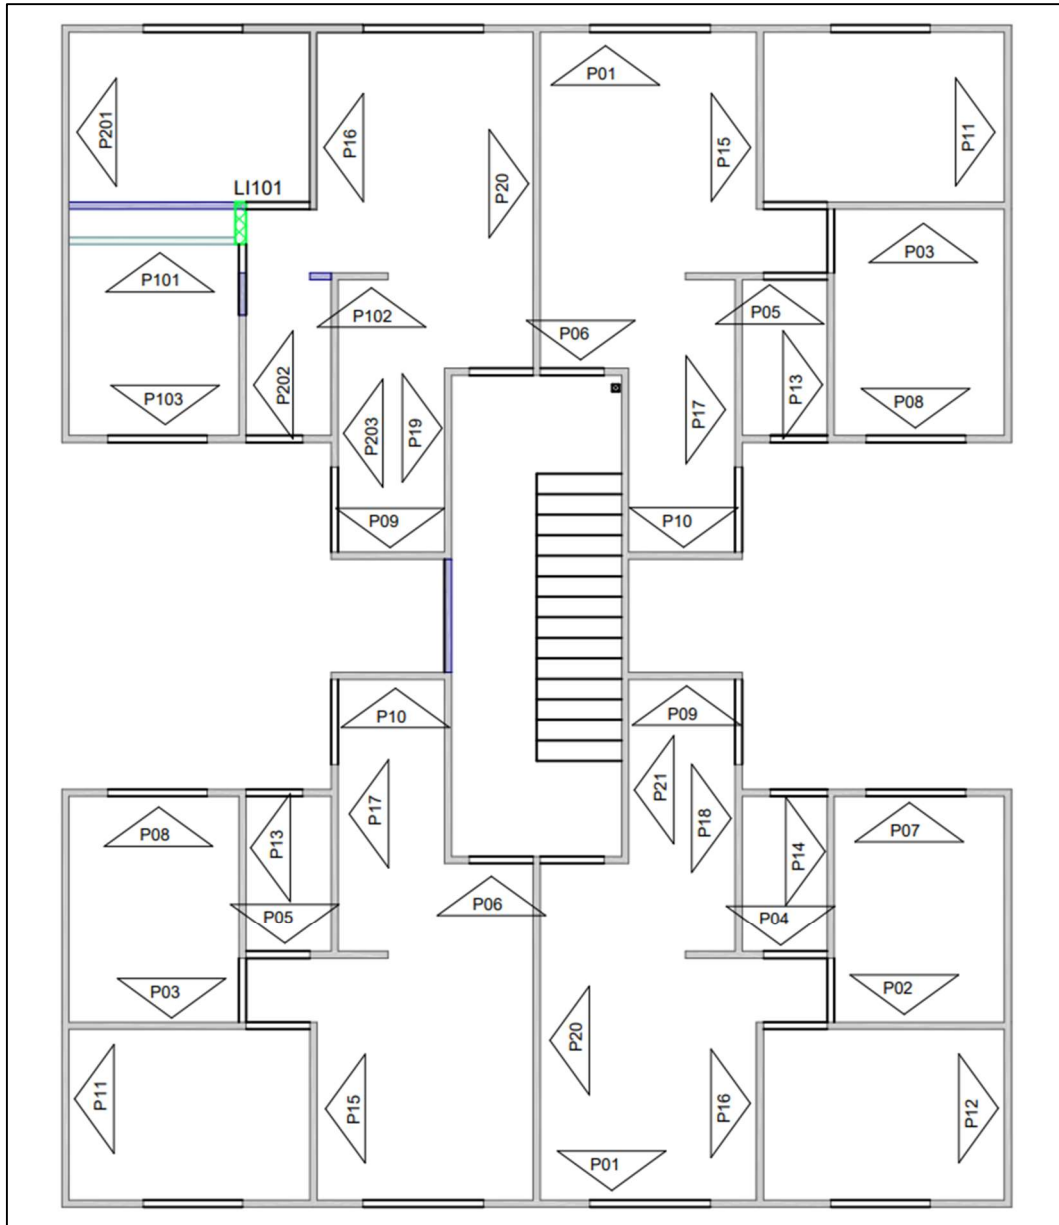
Indicação da parede excêntrica do apartamento adaptado PNE (Fonte: fornecido pela Empresa).
